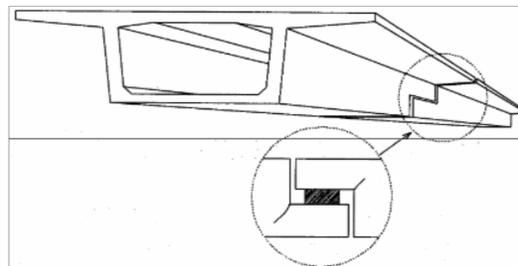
ゲルバーヒンジ部付近のひび割れ
